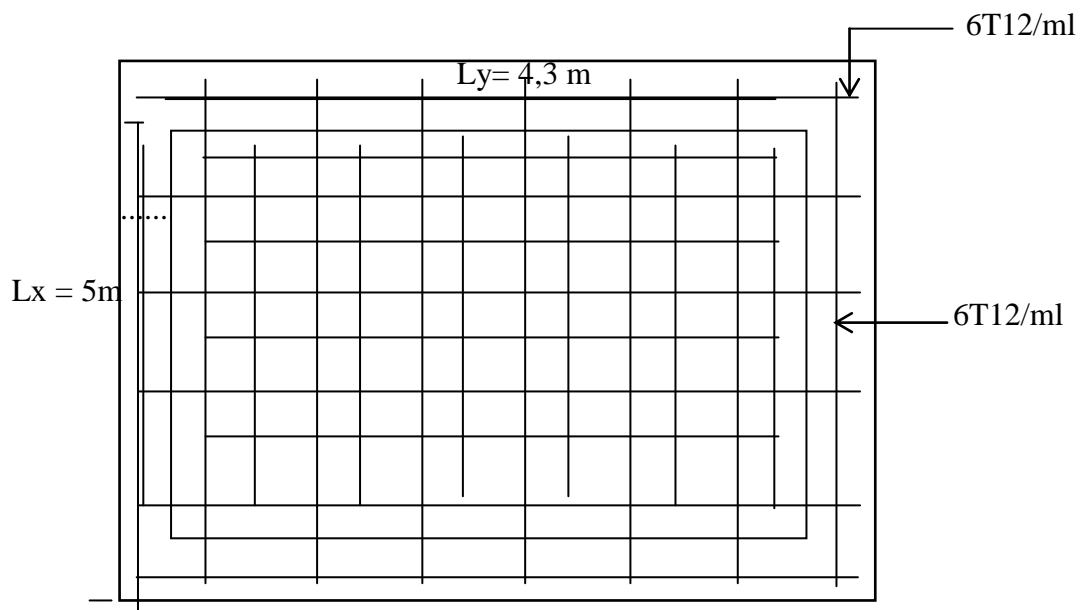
Schéma Ferrailage inférieur du panneau de la dalle pleine.
